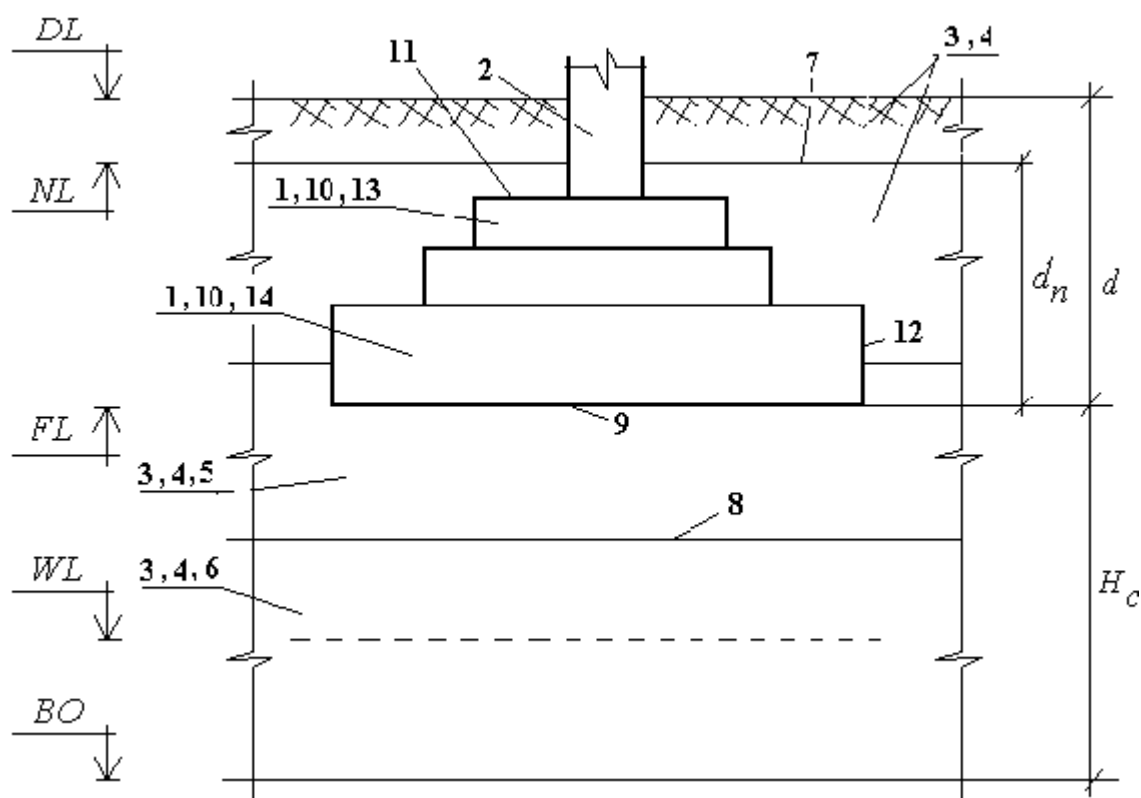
Система «Основание – фундамент мелкого заложения – надфундаментное строение» (схема).
